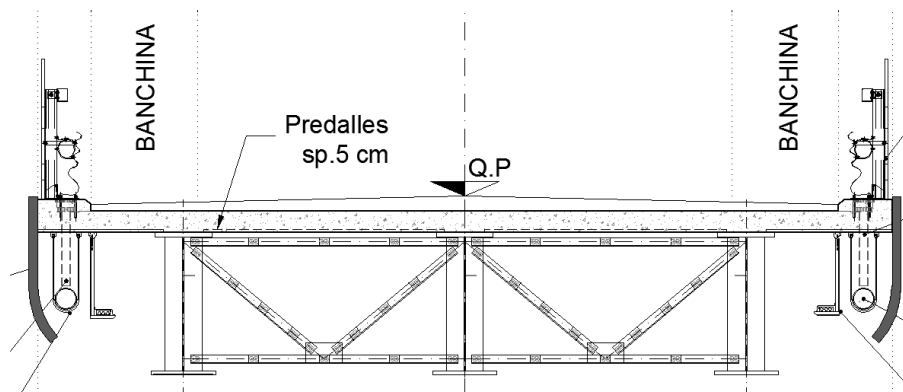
Sezione trasversale dell'impalcato campata centrale
